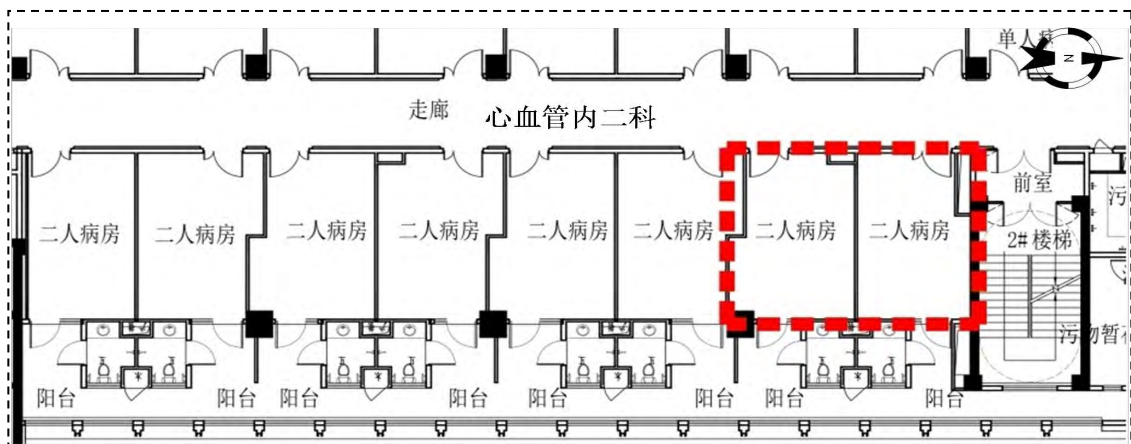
DSA 机房上方楼层平面布置图（老年医学中心楼十七楼）
